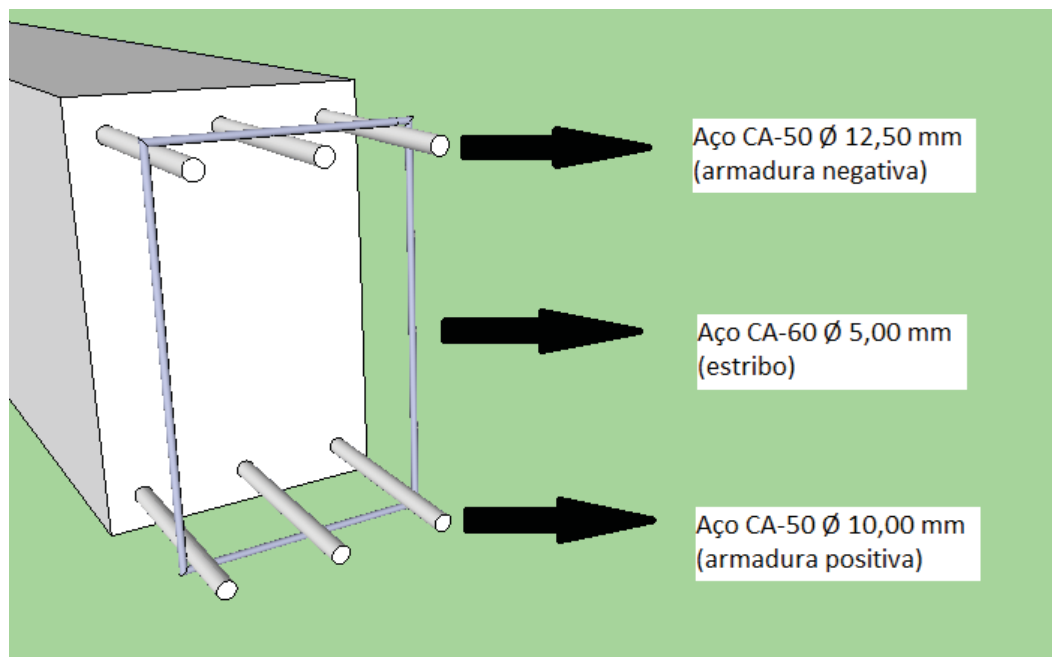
Detalhe da armação da viga baldrame (*Fonte: do autor*)
